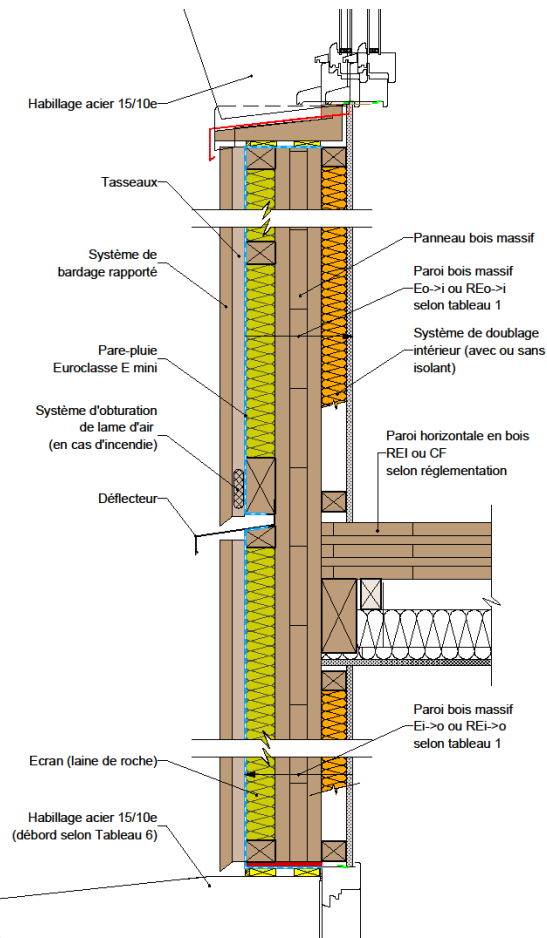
Façade/mur en panneaux bois massif & plancher en panneaux bois massif.
